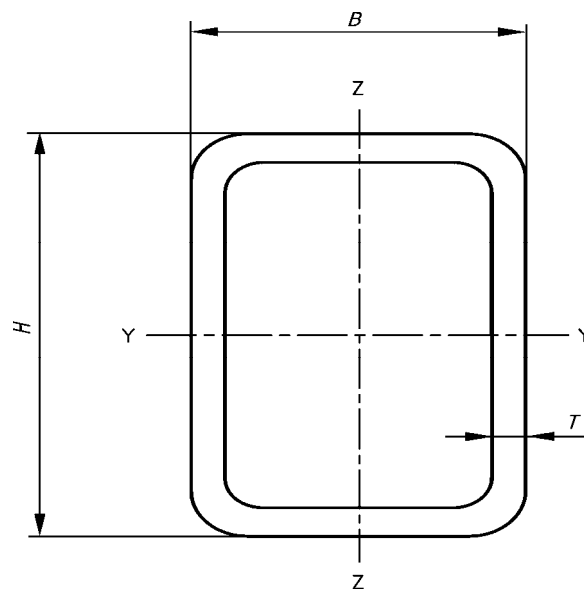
Hohlprofil mit rechteckigem Querschnitt
